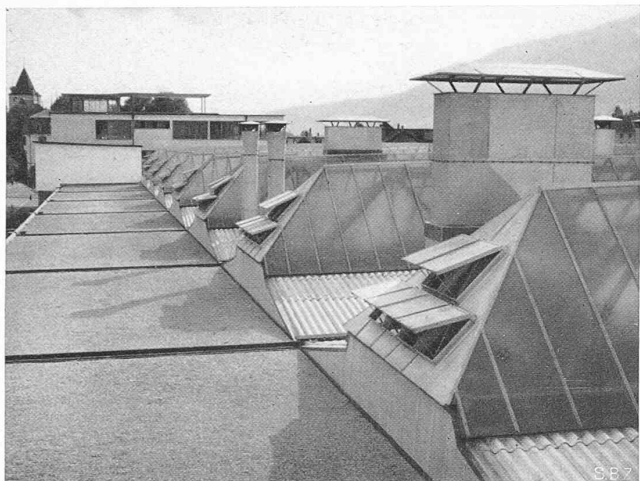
Oberlichter und Flachdach über dem Laufenden Band, hinten Verwaltungsbau mit Dachgarten (links Schloss Nidau)
